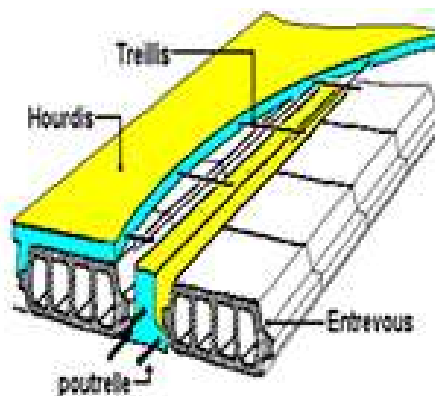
Détail plancher à corps creux. (Source : Construction Bâtiment)
